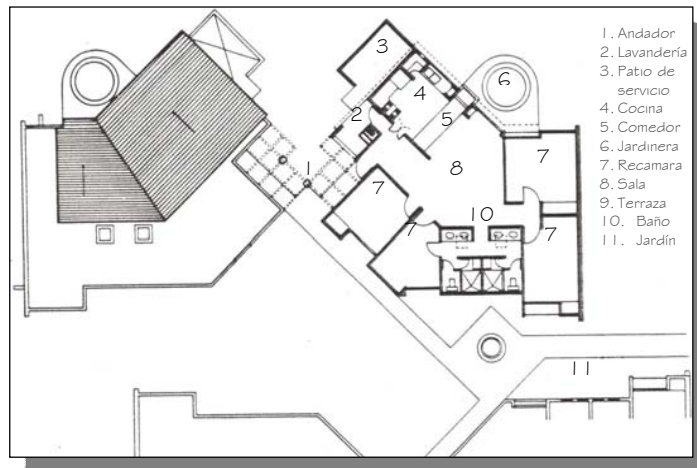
Planta casa tipo, Aldea infantil S.O.S.
